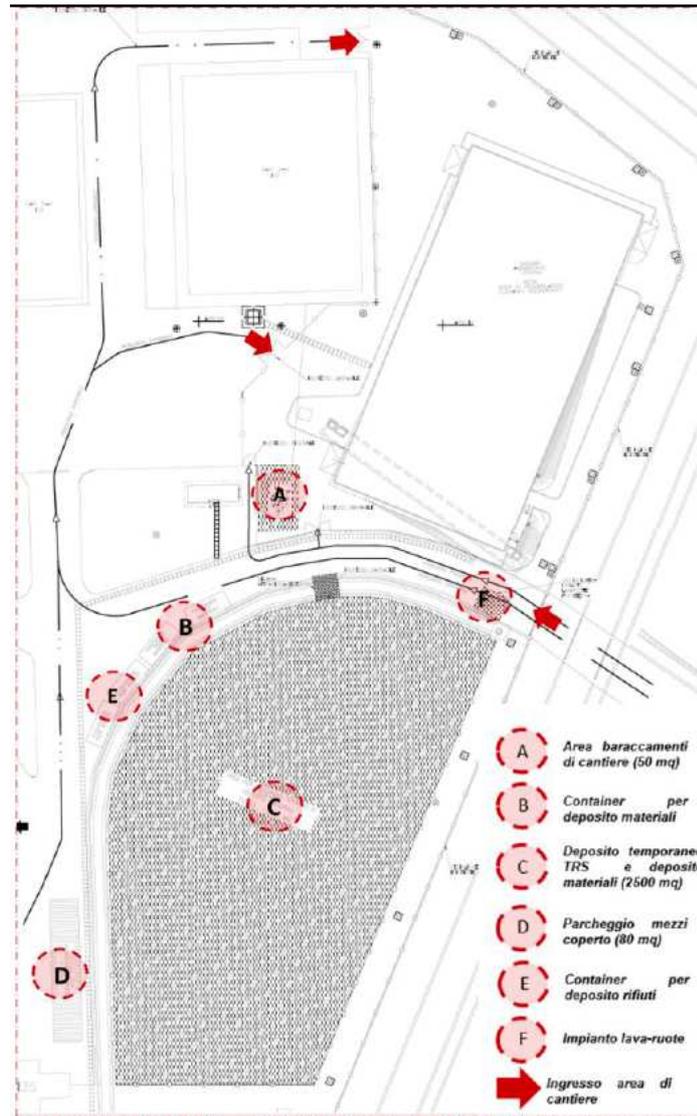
layout di cantiere (pag. 76 dello SPA)
